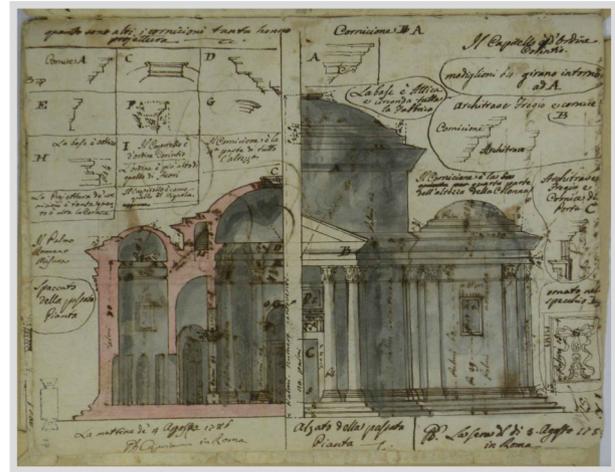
Tempio antico, metà sezione e metà prospetto con particolari.
